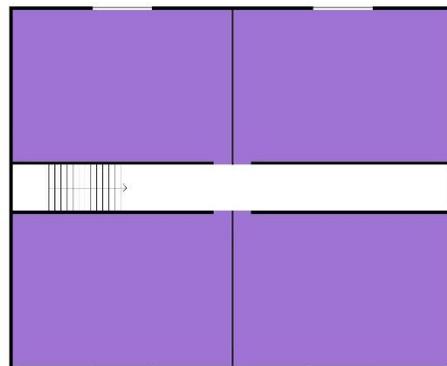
Cantidad de departamentos por piso. Fuente: Elaboración propia.
